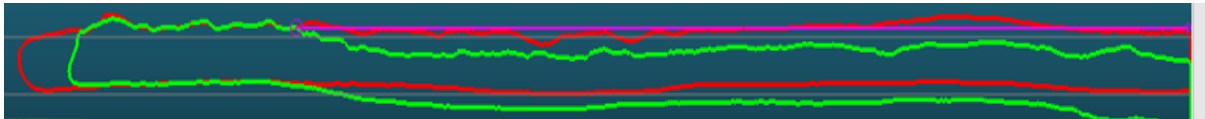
Vista longitudinal de corte en rebaje 2200. (geología, 2024)
